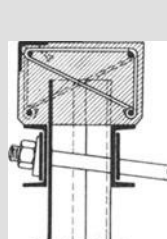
Verankerung der Larssenspundwand u. Kopfausbildung in Eisenbeton (Larssen).
